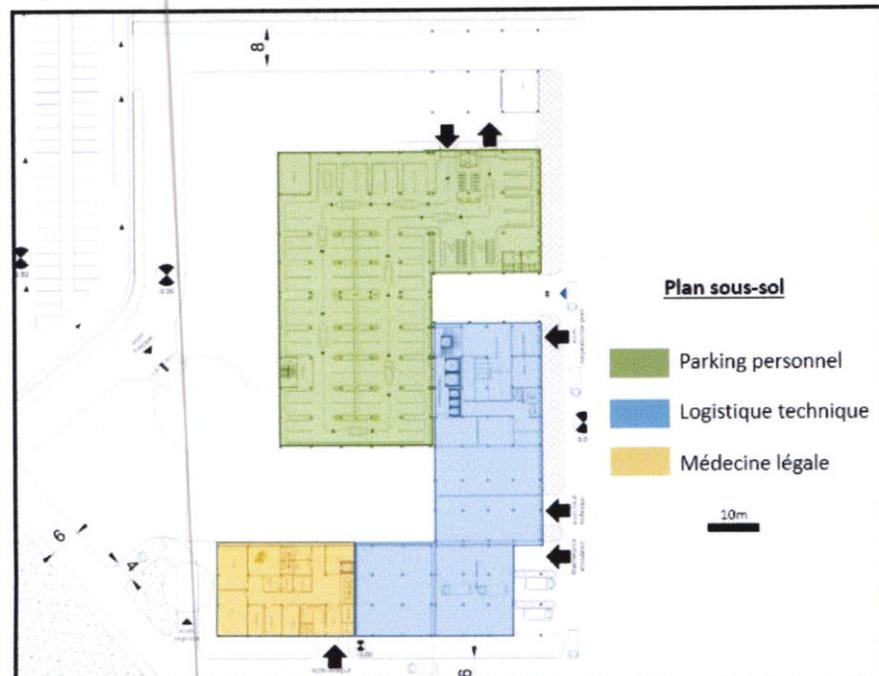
Plan sous-sol-Agencement des unités fonctionnelles Source : Auteurs
